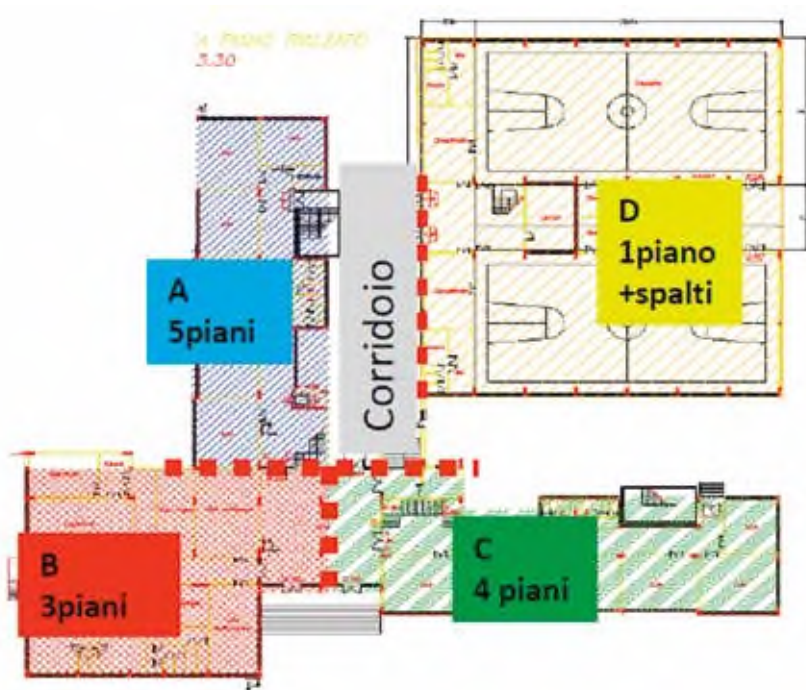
Vista planimetrica del piano rialzato dei quattro corpi di fabbrica
